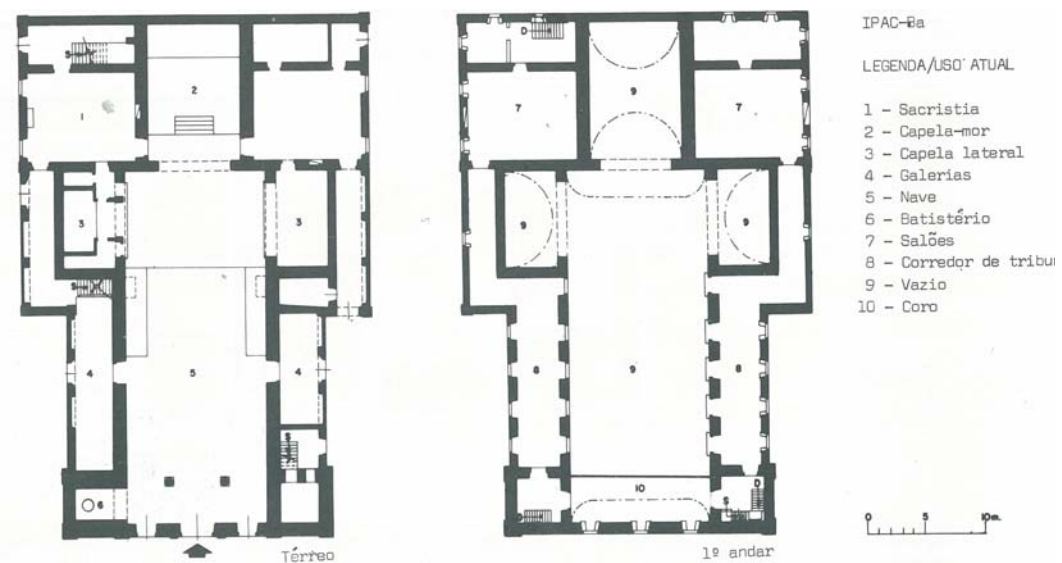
Planta da Igreja Matriz de São Bartolomeu
